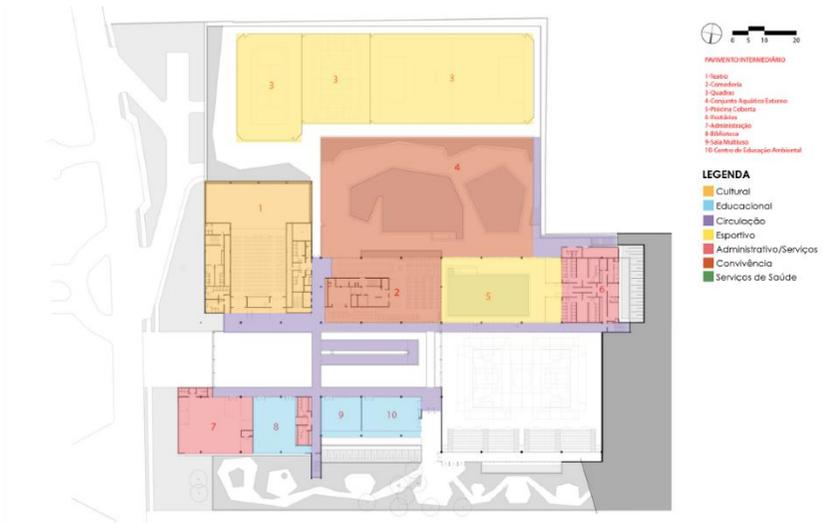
Planta Baixa SESC Guarulhos – Pav. Intermediário: estudo usos e zoneamento. (Archdaily, 2019 – editado pelo autor)
